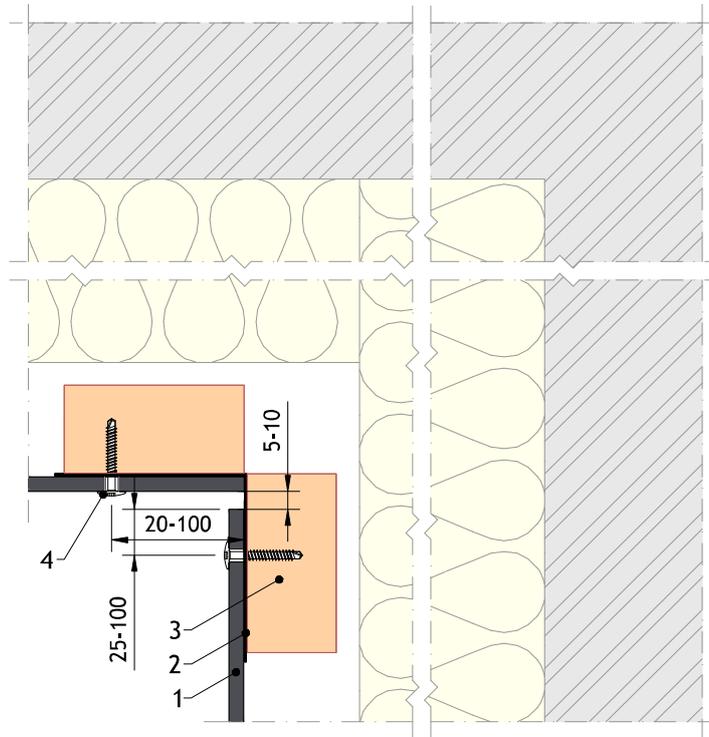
Außenecke - Biegesteif mit optionaler Windsperre
